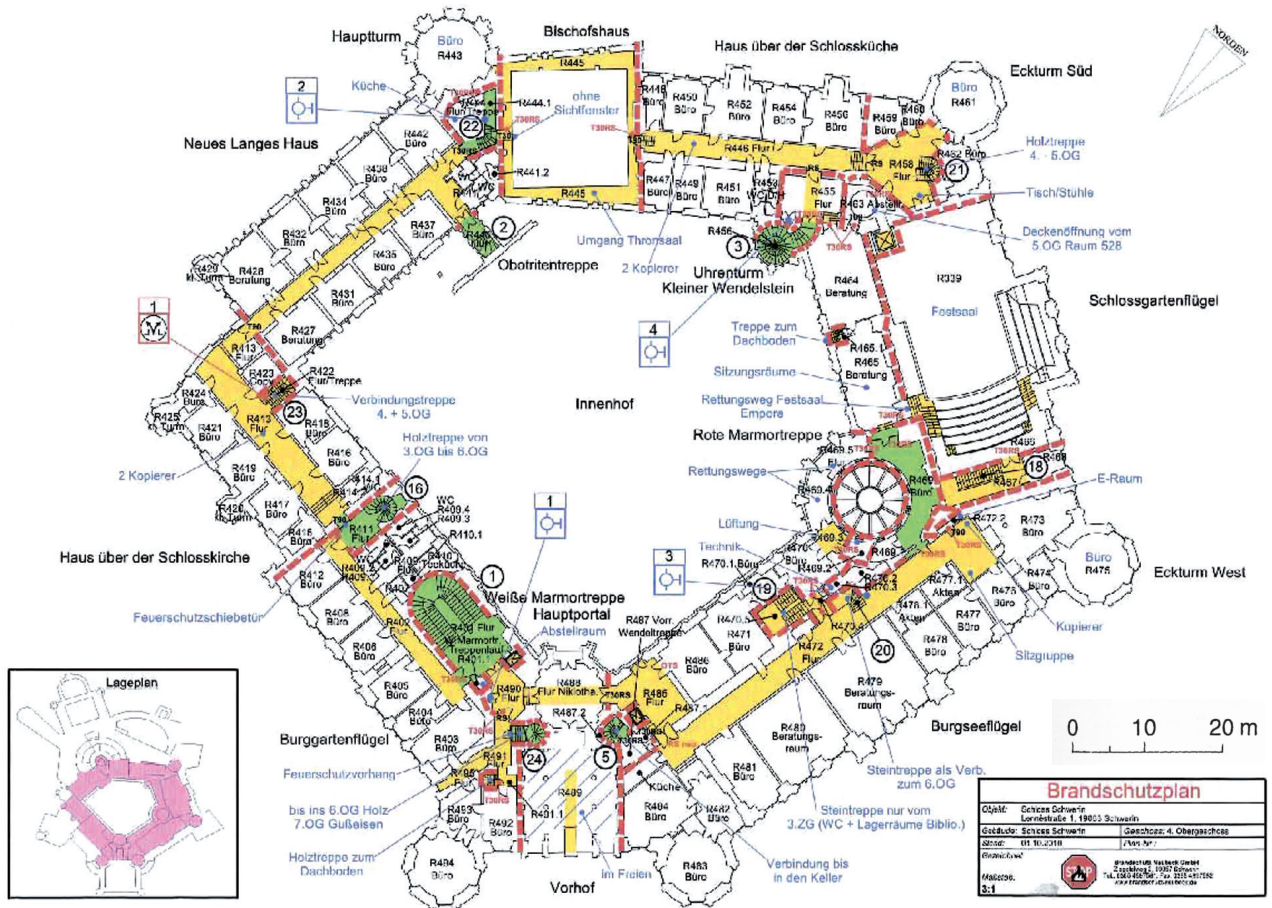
Grundriss des vierten Obergeschosses⁹.
